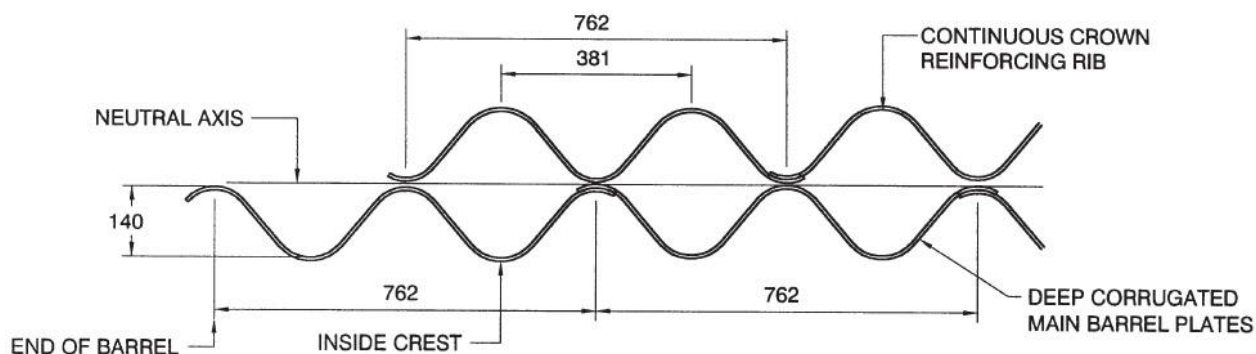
Refuerzo o costilla para tubos de acero corrugado. Fuente: Handbook of Steel Drainage & Highway Construction Products (2007)
